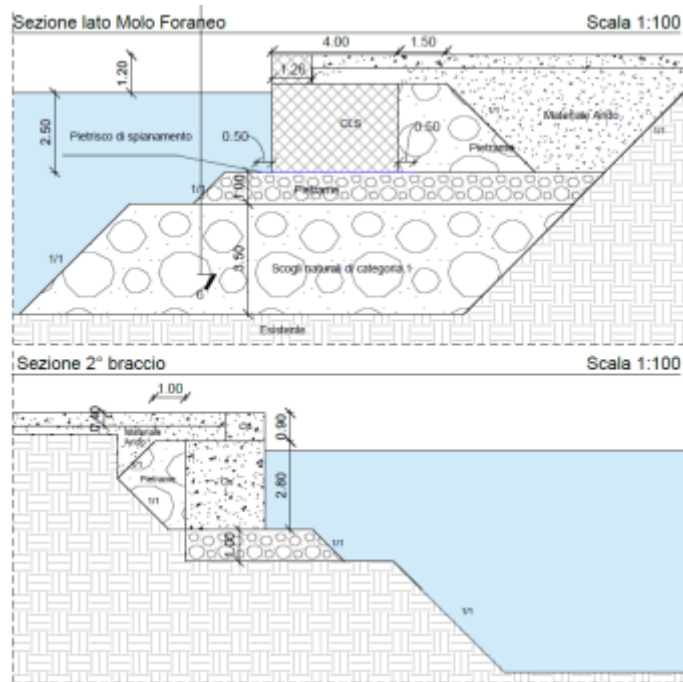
Particolare sezione di progetto lato Molo Foraneo e 2^a braccio
